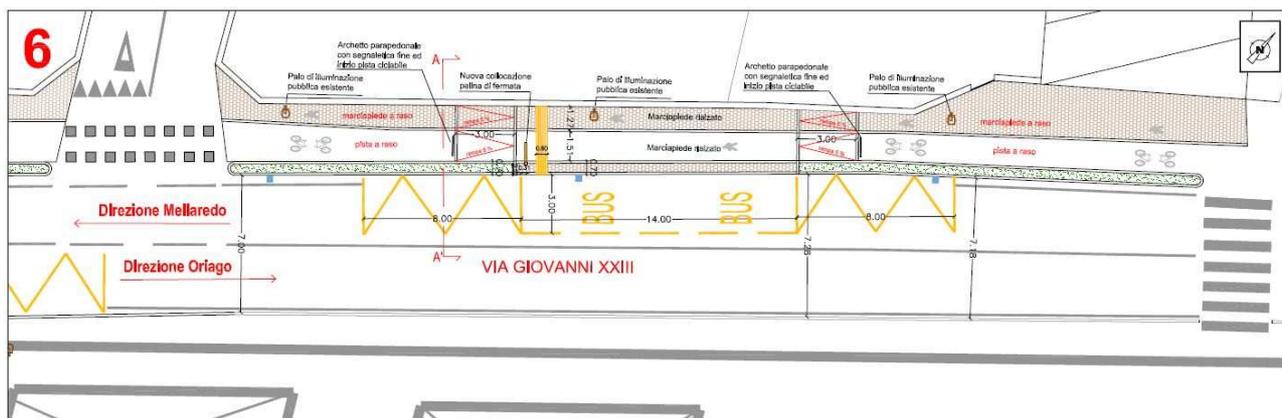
Progetto fermata n. 6 linea Oriago - Mellaredo, direzione Mellaredo
